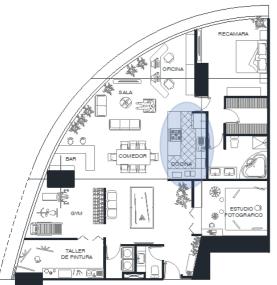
Diagrama de funcionamiento. Planta Arquitectónica departamento torre Mitikah. Elaboración conjunta, Álvarez, González, Hurtado. 2022
